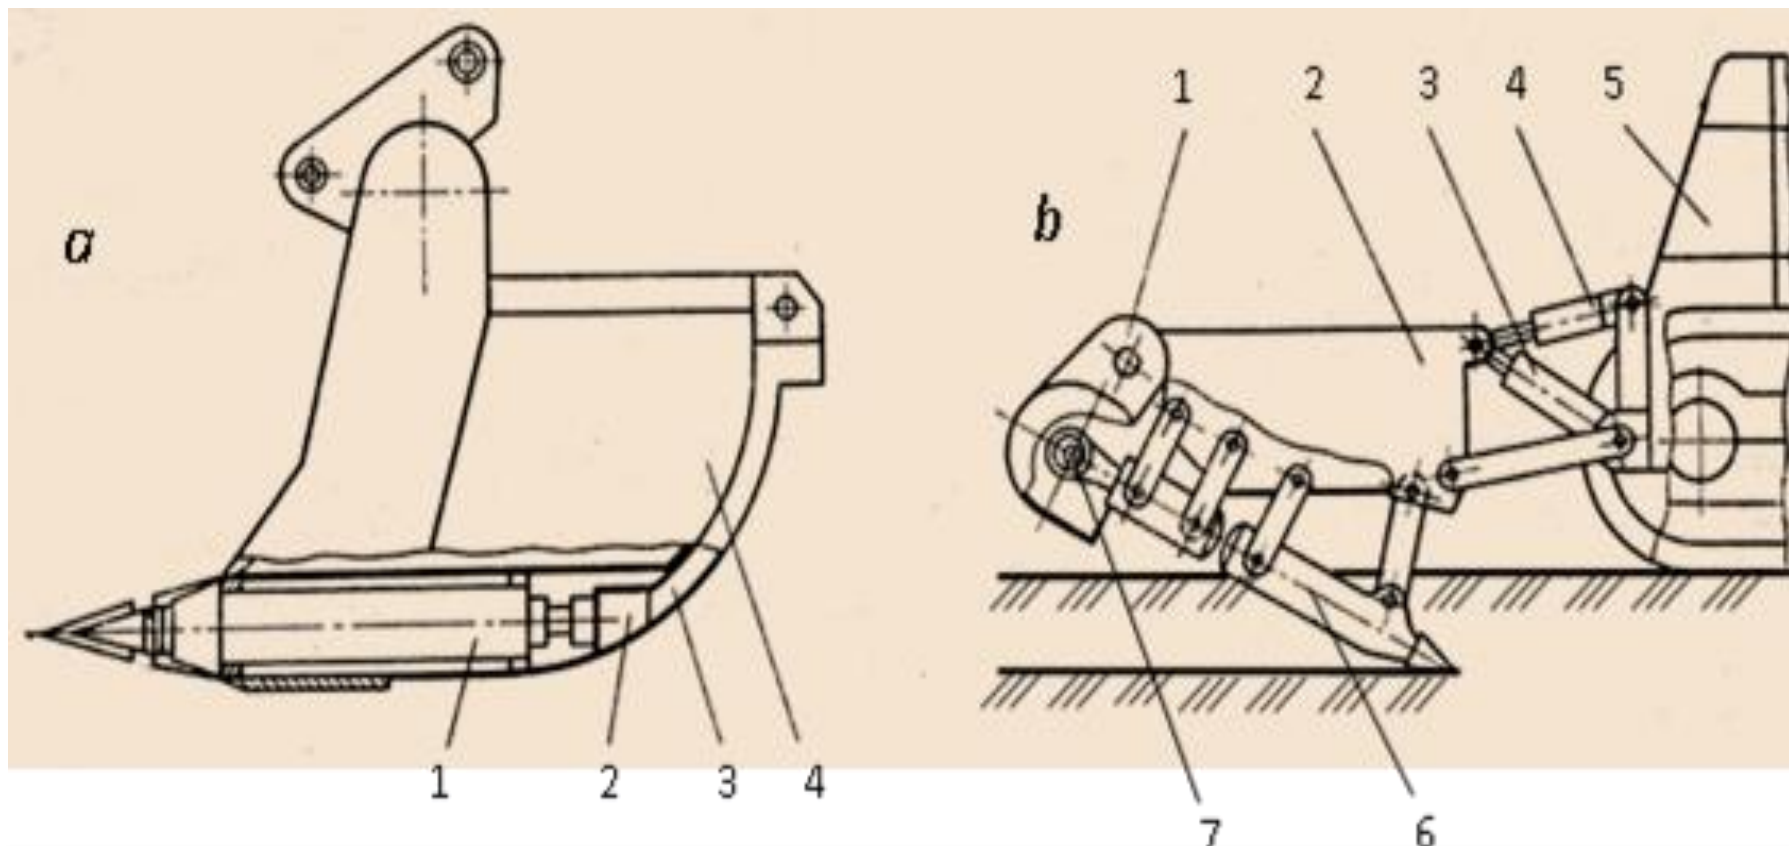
Сменное рабочее оборудование к экскаваторам ЭПЦ-161 и ЭПЦ-165 для разработки мерзлых грунтов:
